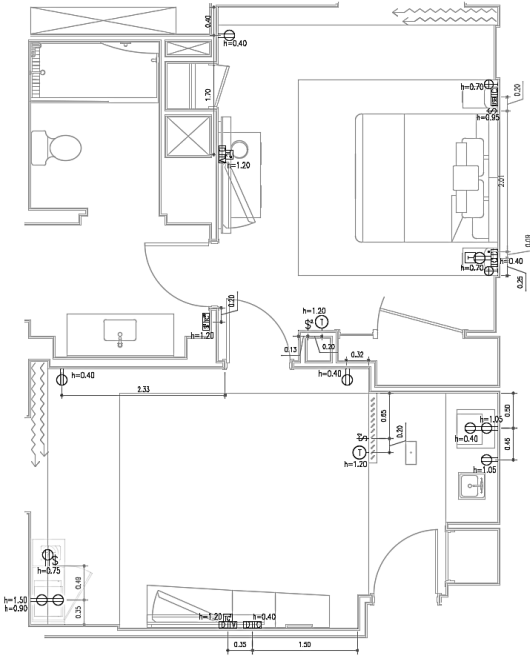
Planta eléctrica King Suite Hotel Courtyard
